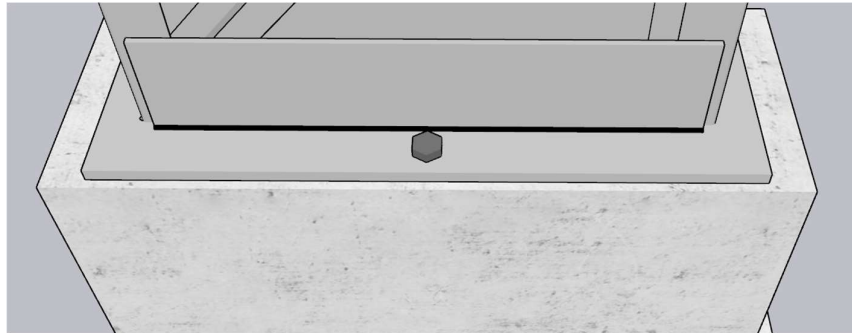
| Esquema de la soldadura adoptada. Fuente: Elaboración propia.
